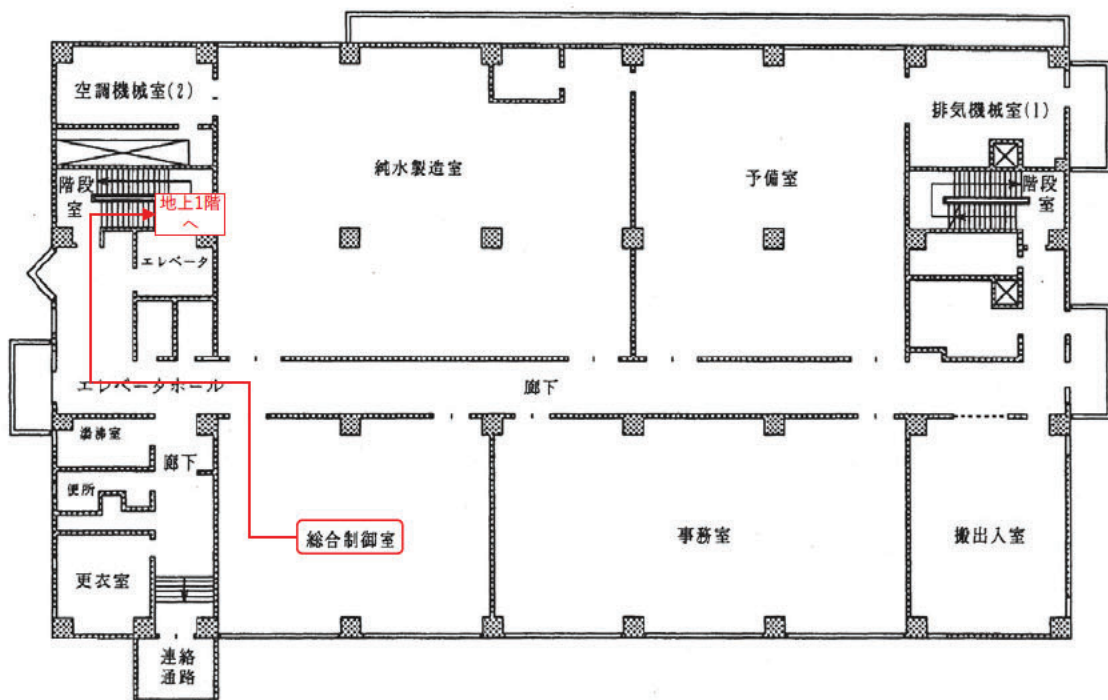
(1) 移動経路 (ユーティリティ施設 3F 平面図)
